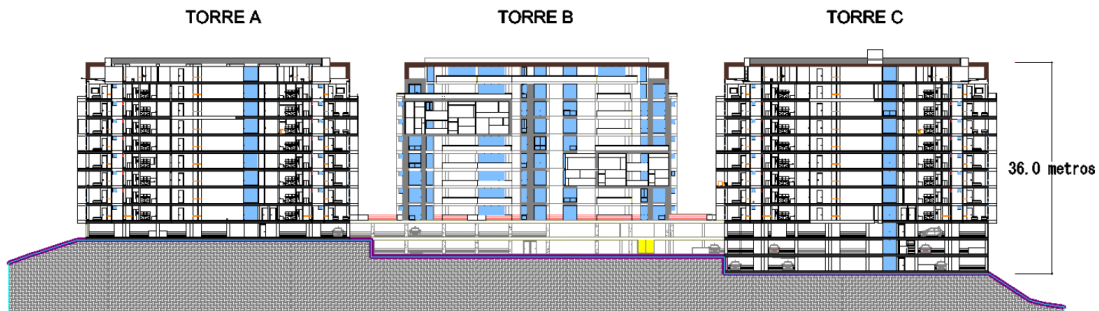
Corte arquitectónico longitudinal donde se puede observar la altura típica.
